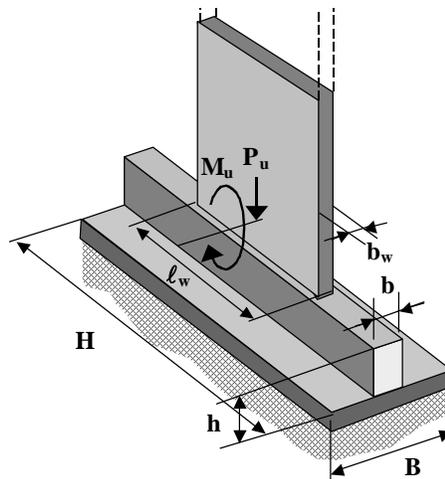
Zapata de muro extendida mediante una viga de cimentación
